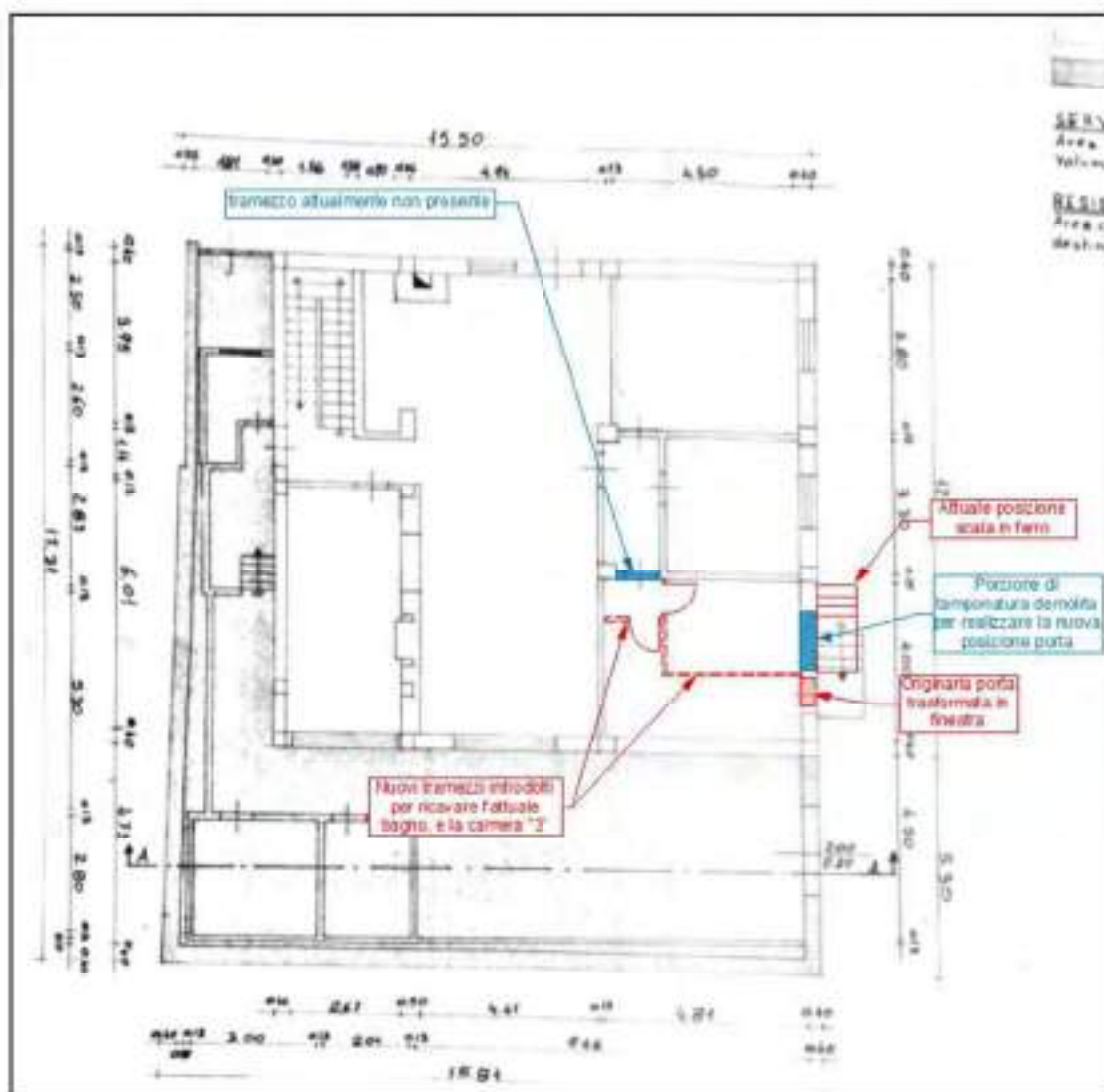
Pianta piano semintervento allegata alla richiesta di condono del 29/03/1986, sanata il 3/08/2005 con indicazione delle difformità rilevate all'interno del sub 1
